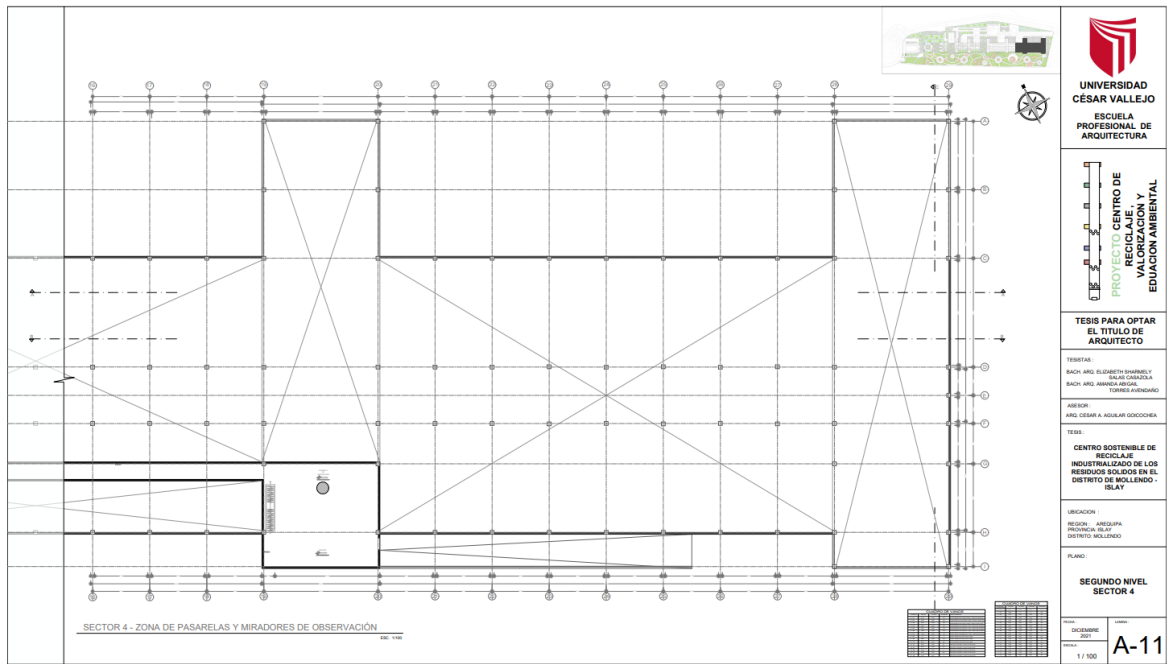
Planta de Distribución, Sector 4 – Segundo Nivel
